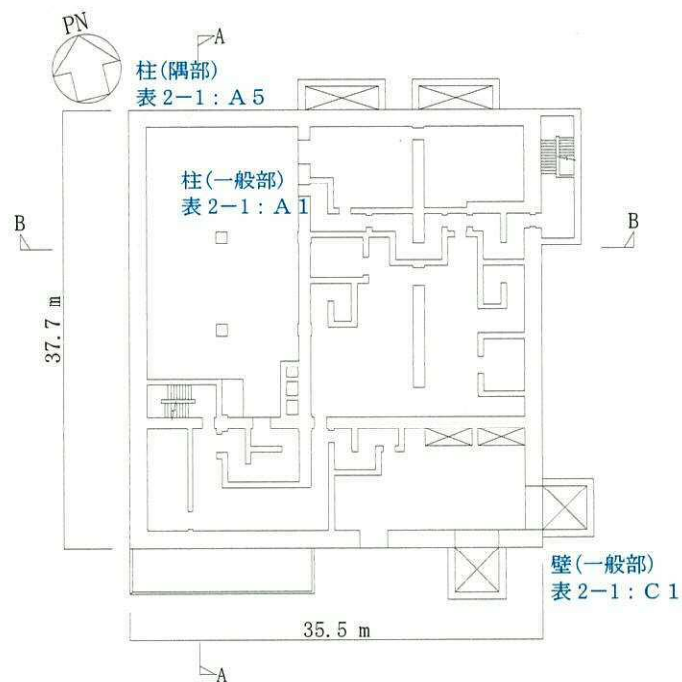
緊急時対策所建屋の概略平面図 (EL. 30.3 m)
